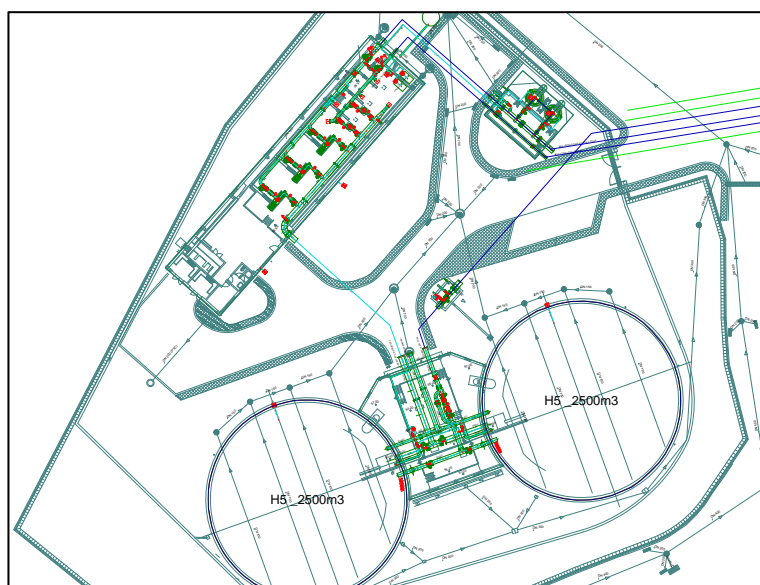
Representação esquemática em planta da Estação Elevatória de Barradas (fonte: Águas Noroeste S.A.)
